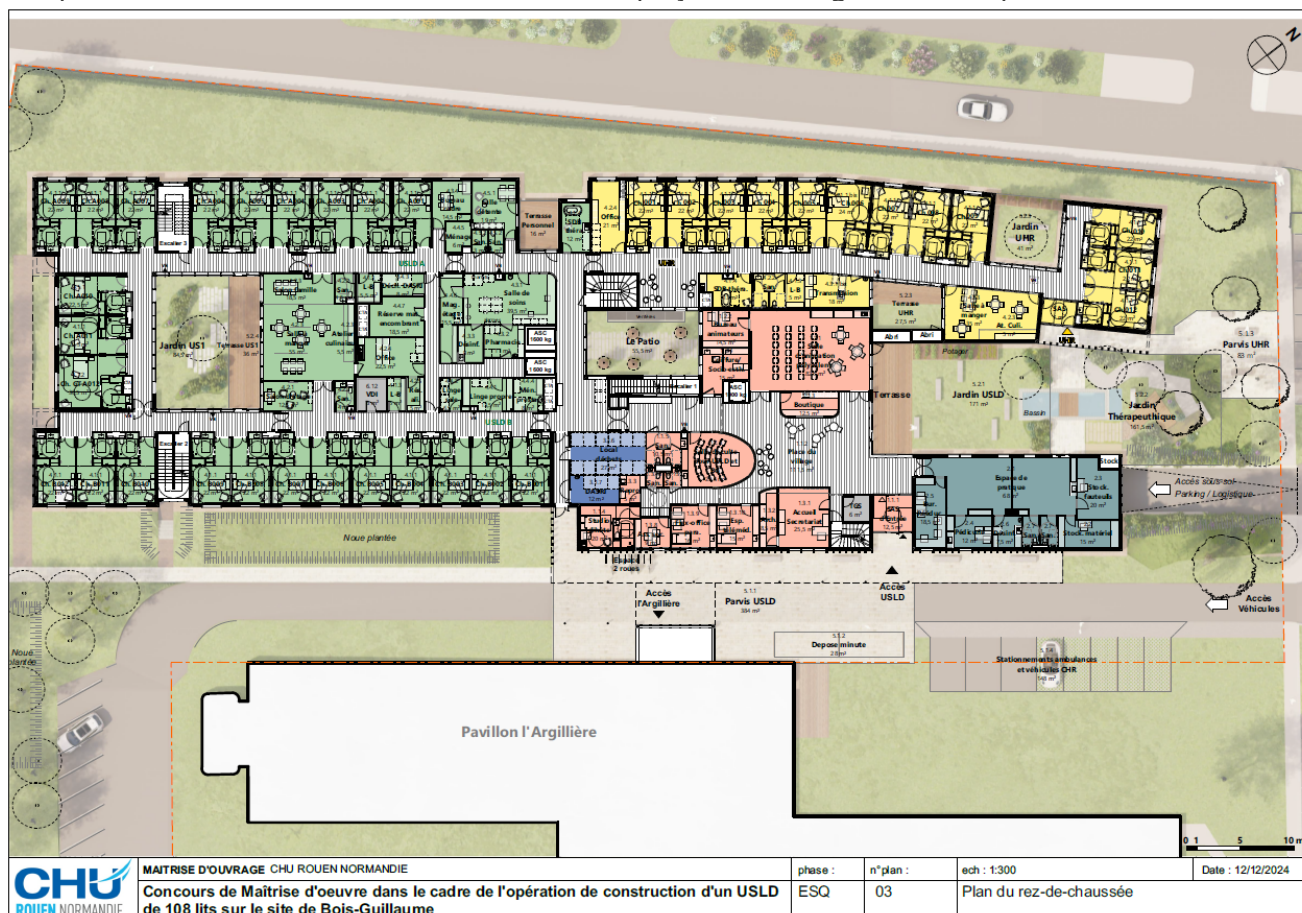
Plan d'aménagement du rez-de-chaussée (source : Client, référence : Phase ESQ, plan n°3, Plan du rez-de-chaussée, plan du 12.12.2024)
